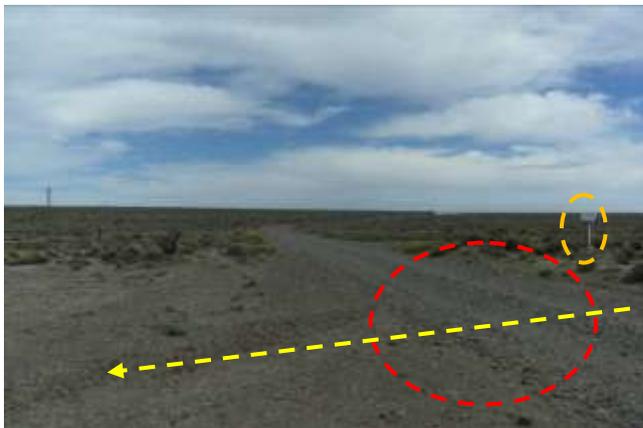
Emplazamiento de gasoducto. Cruce con camino (rojo). Se observa cartel de gasoducto troncal (anaranjado). Foto en dirección SSO.
